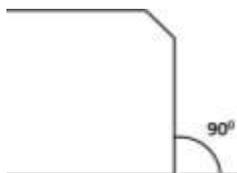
Detalhe do ângulo de inclinação da peça de concreto
